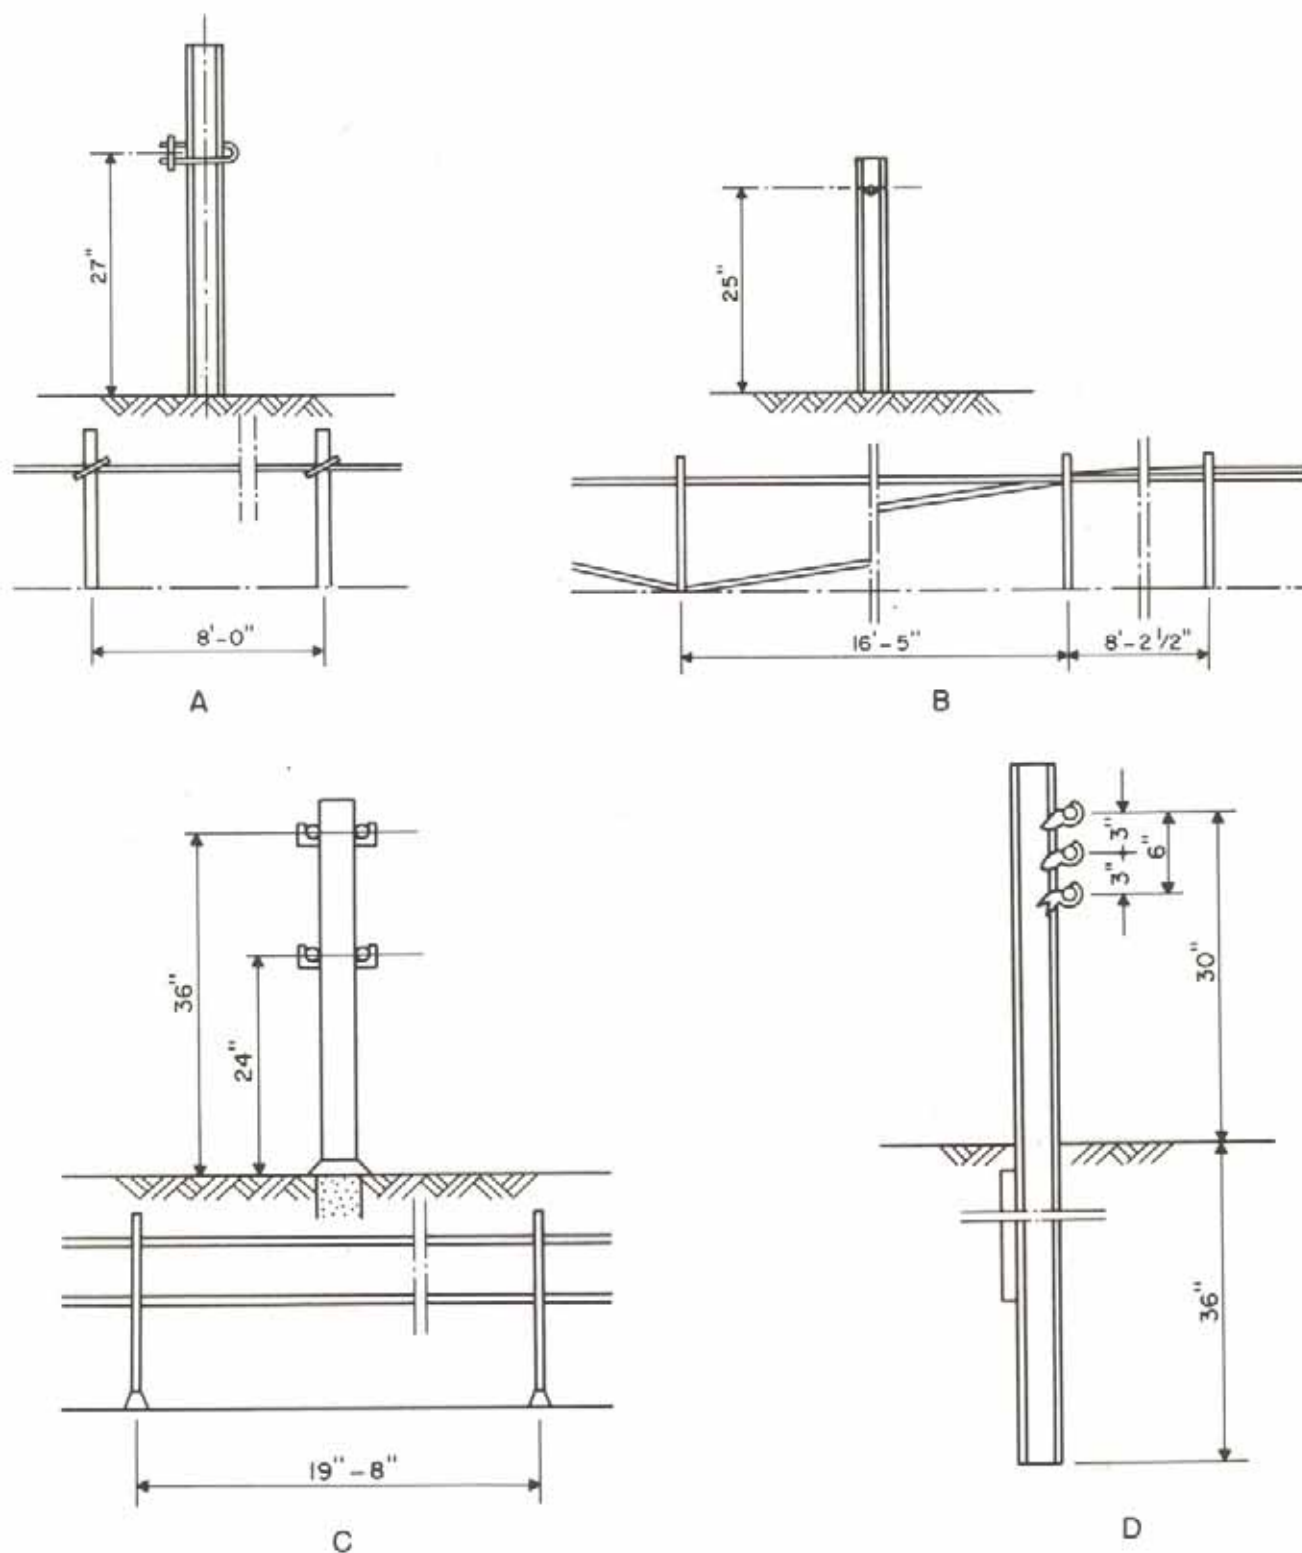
Defensas flexibles y barreras. a. Barrera de cables (California). b. Barrera de cables (Reino Unido). c. Barrera de cables (Baden Wurtemberg). d. Barrera de cables sobre poste débil (Nueva York).
